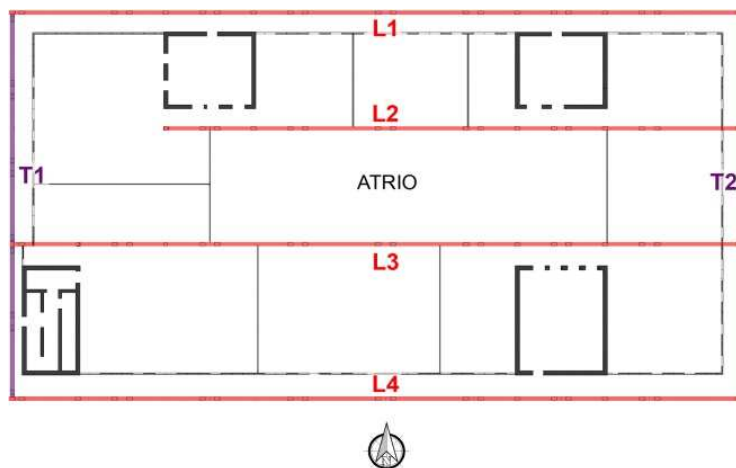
Disposición en planta primera de las armaduras en relación con los núcleos y atrio. La nomenclatura L1-L4 corresponde a las vigas longitudinales. T1 y T2 indican las vigas transversales. (Realización propia)
